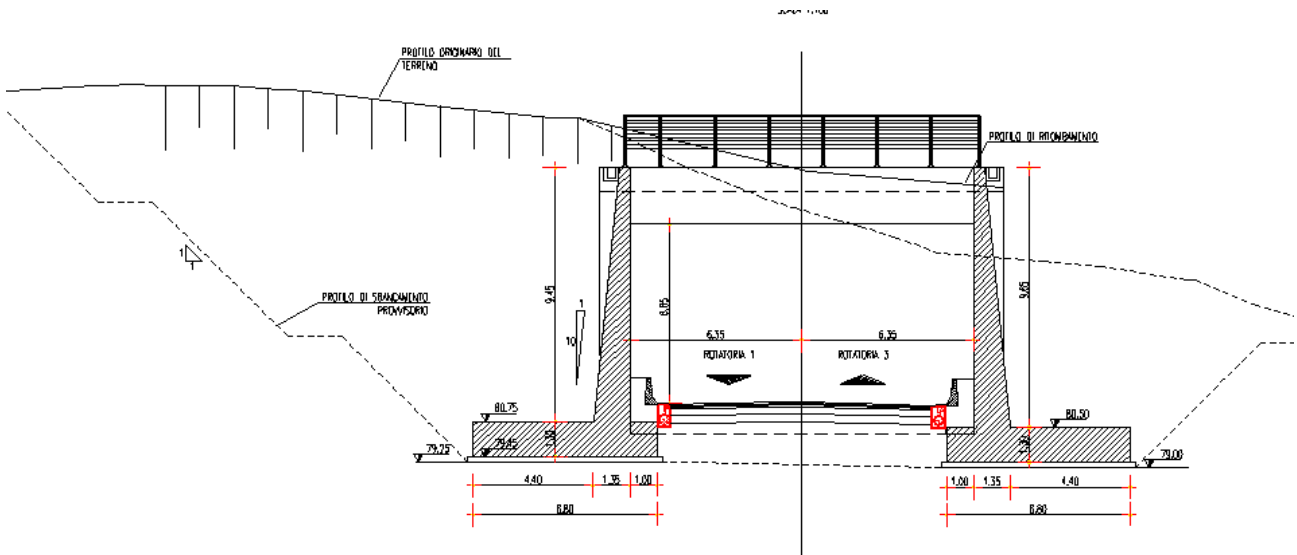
Sezione trasversale imbocco Galleria Artificiale Asse 1-3
